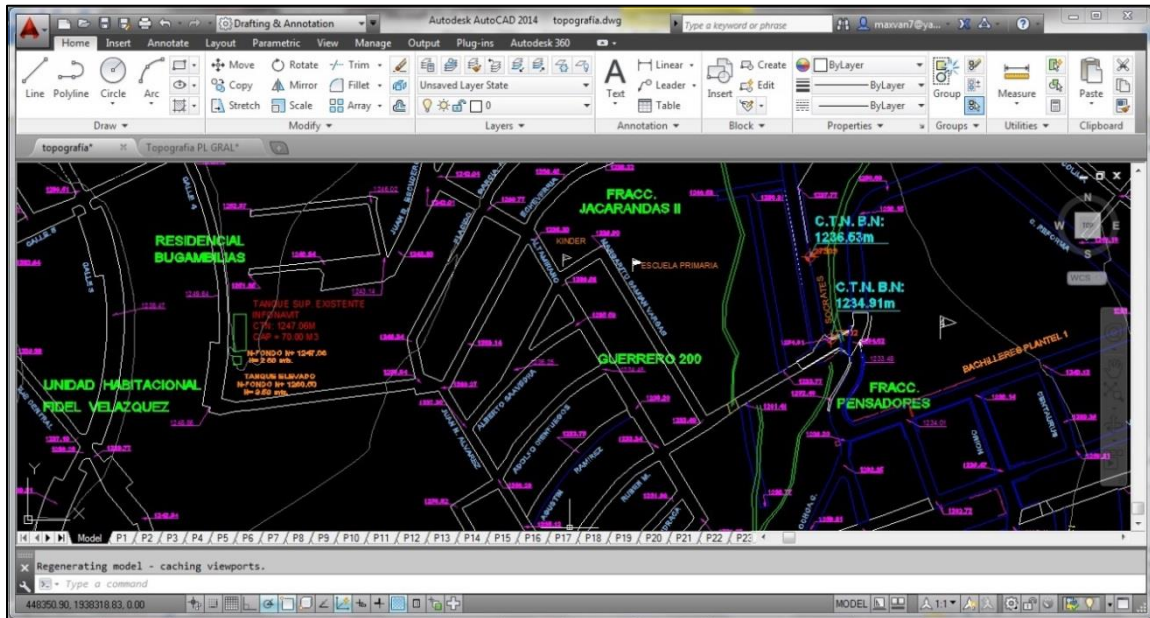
Detalle del plano de topografía en AutoCAD
